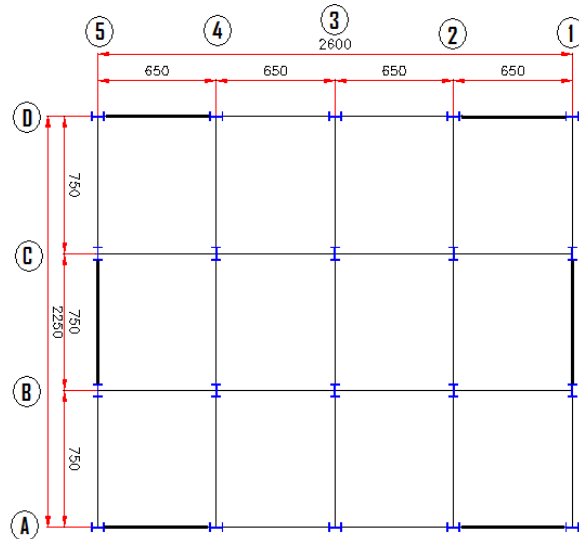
Dimensiones (cm). Planta Edificios de 12 Niveles.
